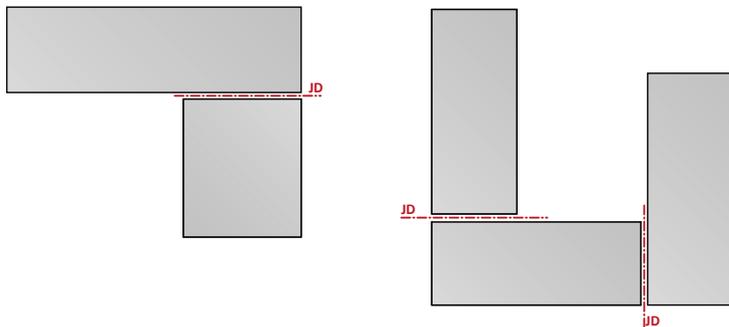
Exemples d'emplacements de joints de dilatation à privilégier (vue en plan)
